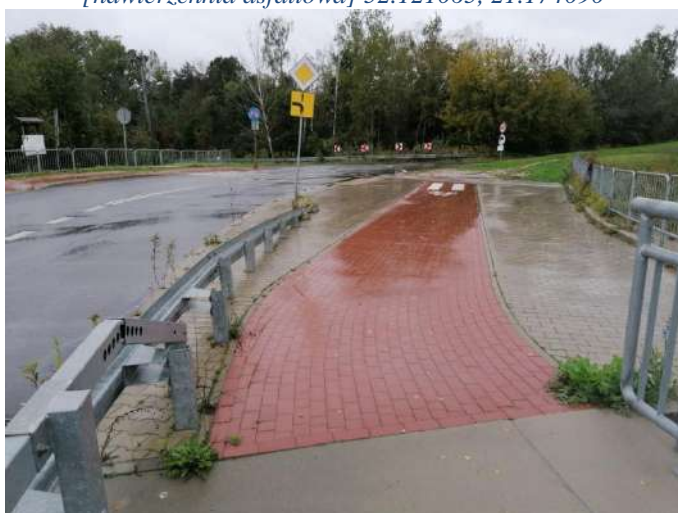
[w kierunku południowym] wał przeciwpowodziowy wzdłuż Jeziorki
